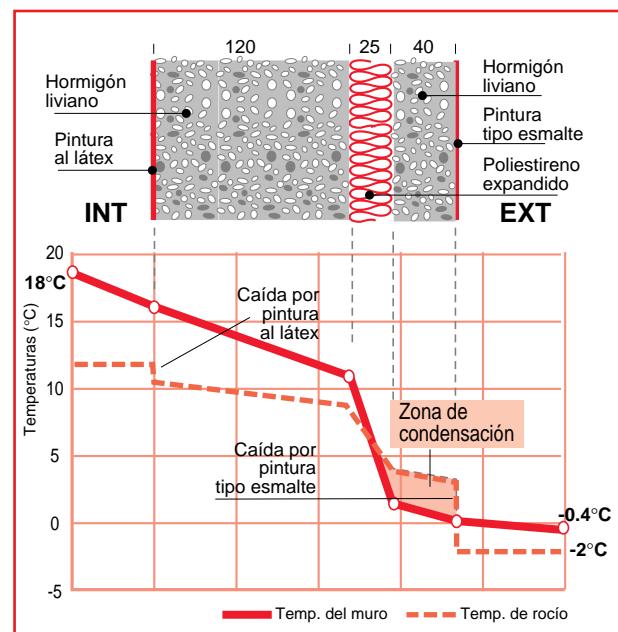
Muro de hormigón liviano con pintura exterior que es barrera de vapor
